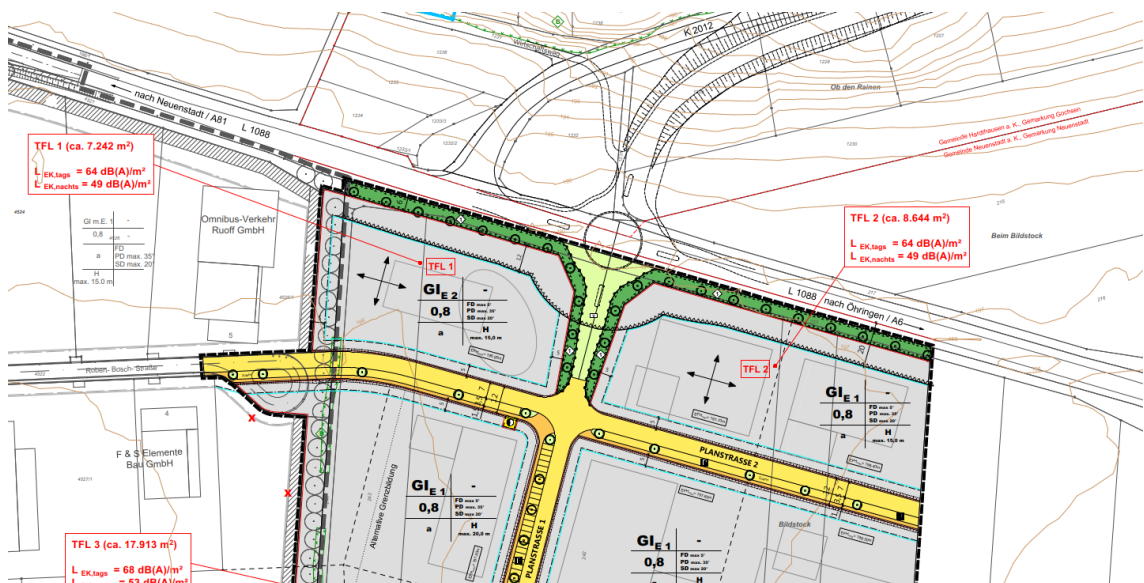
Auszug aus dem seit 2017 rechtskräftigen Bebauungsplan „GIK-Erweiterung – 1. BA“ des Zweckverbands Gewerbe- und Industriepark „Unteres Kochertal“ (Quelle: Stadt Neuenstadt a. K.)
